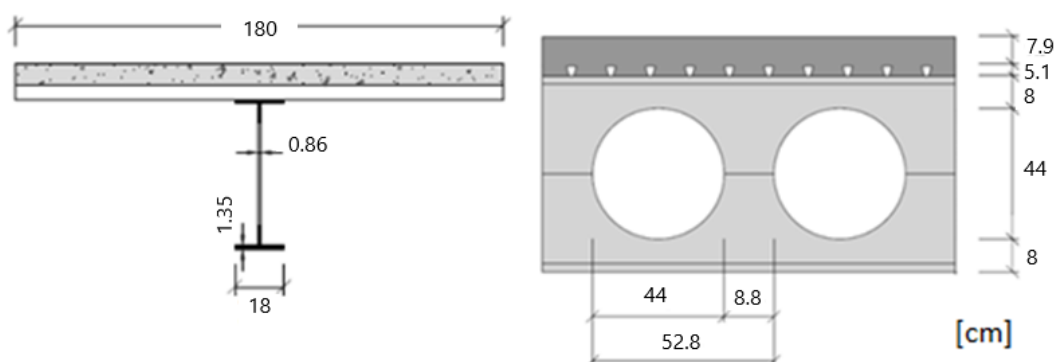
Geometria da viga CE2 (adaptado de BENINCÁ E MORSCH, 2020)
